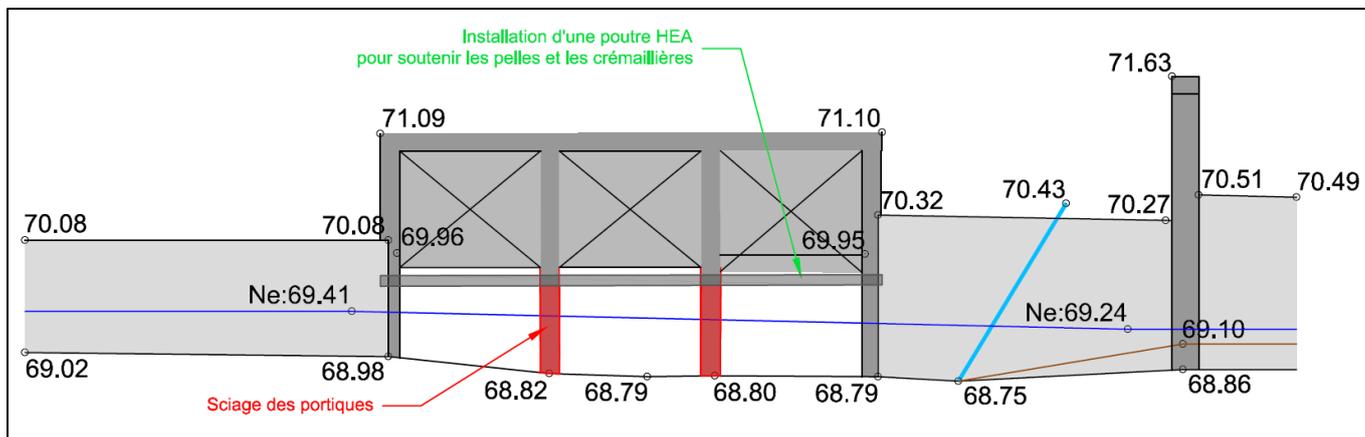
Profil en travers au droit de l'ouvrage du bief rive gauche (PT11)
